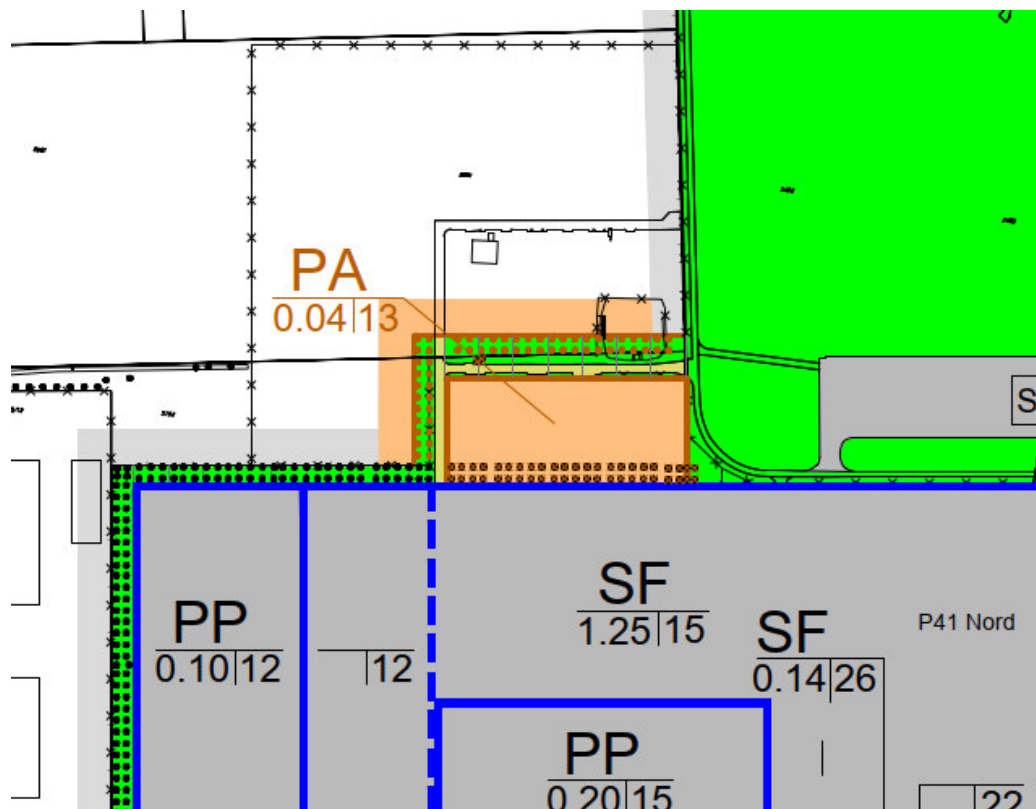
Auszug aus dem geänderten Plan der baulichen Anlagen.
